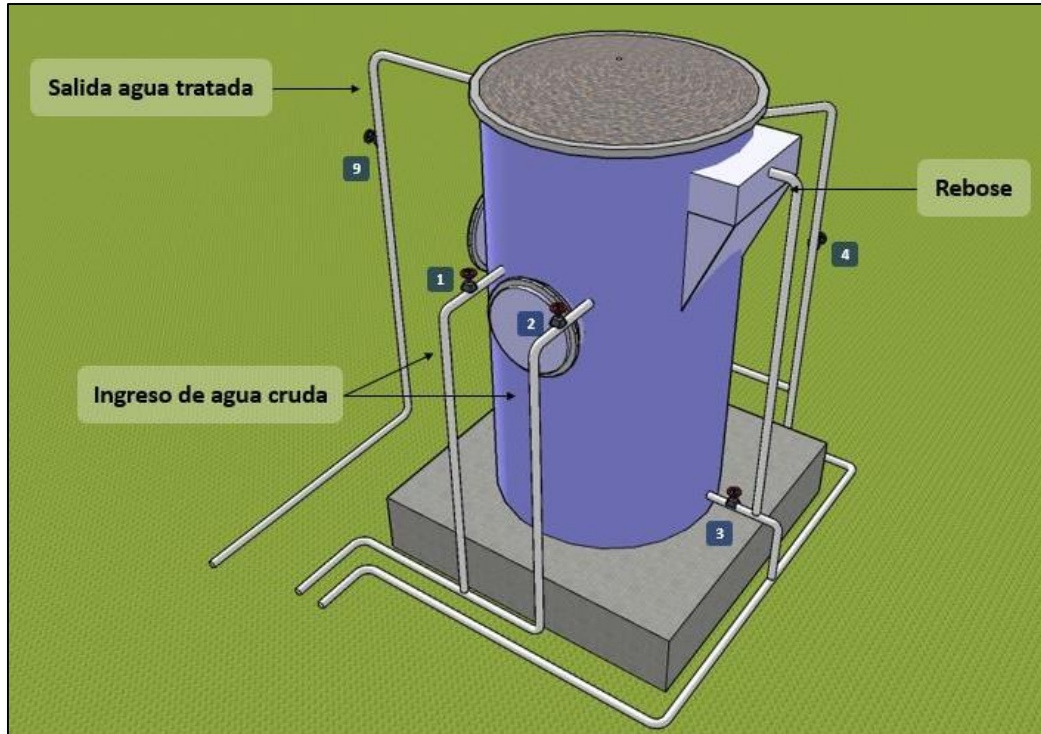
Esquema frontal Planta Q=0,5 L/s
